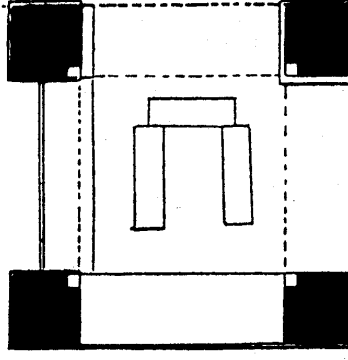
مسقط أفقي لقبة الشيخ سنان يدرب قرمز بالقاهرة
